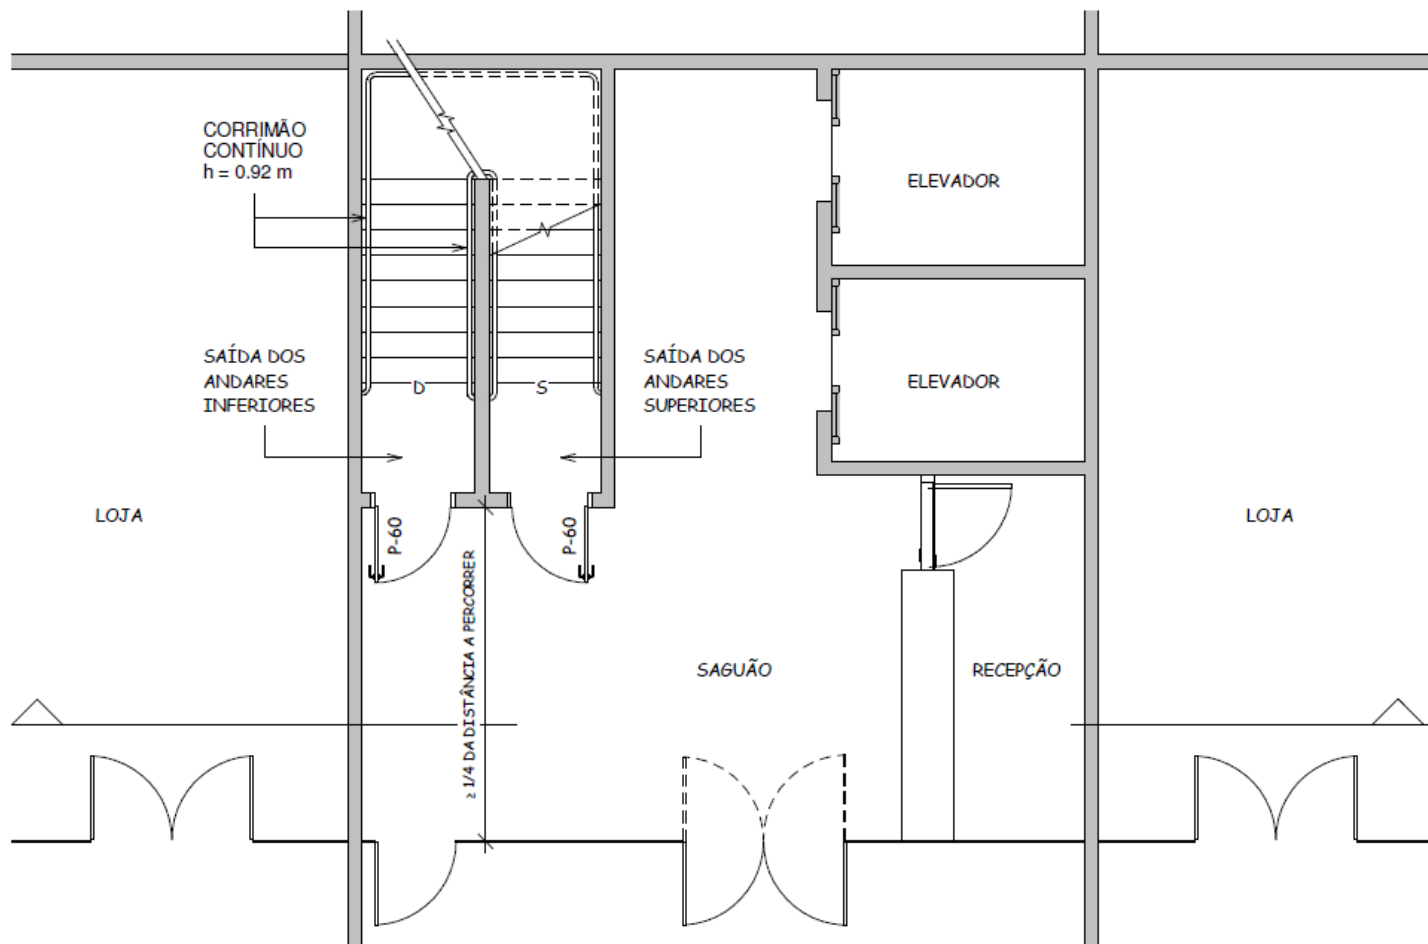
A - Descarga com independência entre pavimentos (planta baixa).
